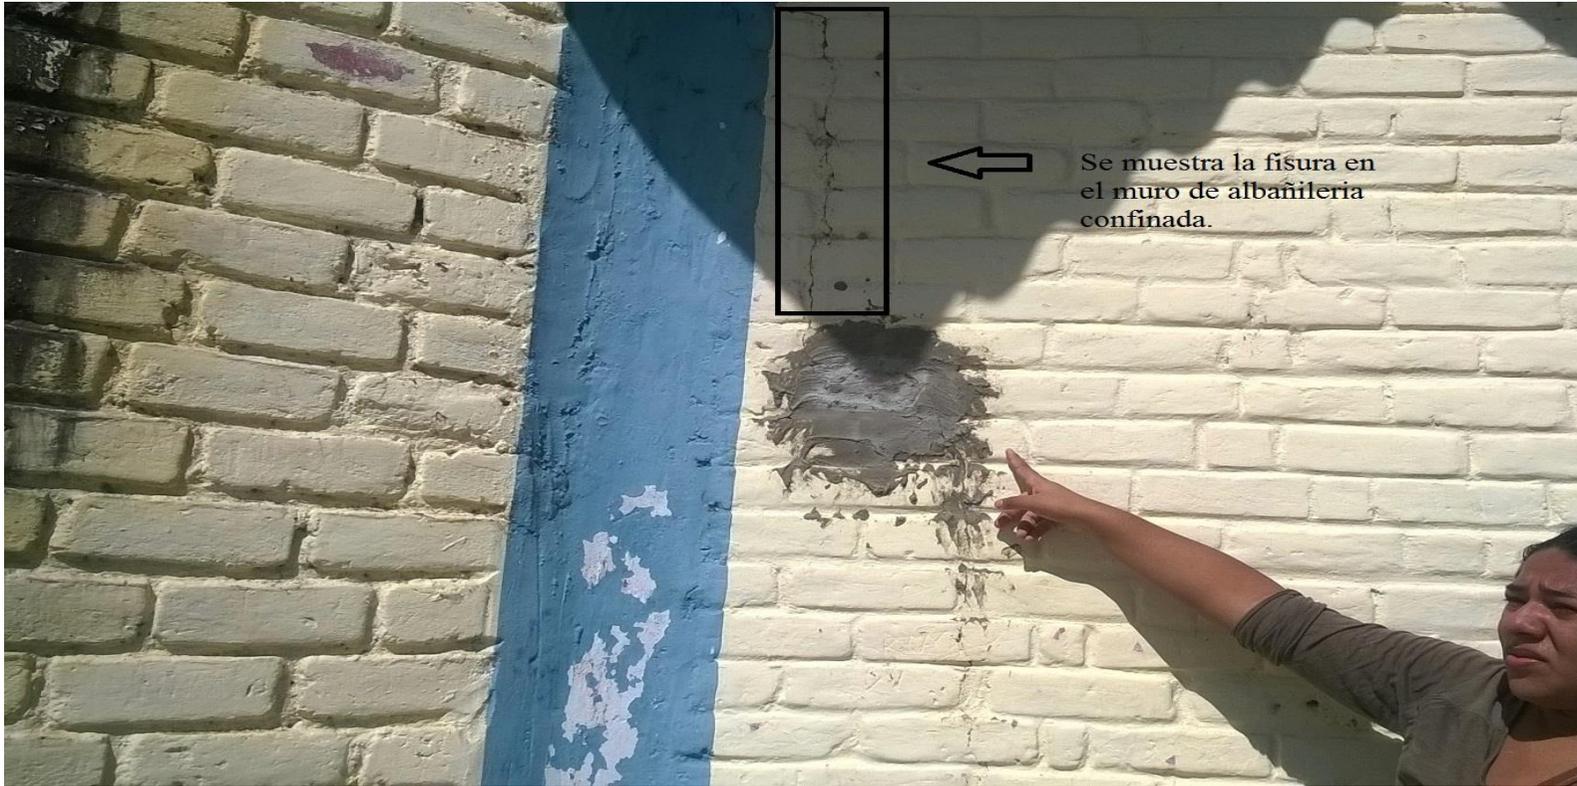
Fisura en el muro de albañilería del cerco perimétrico.
